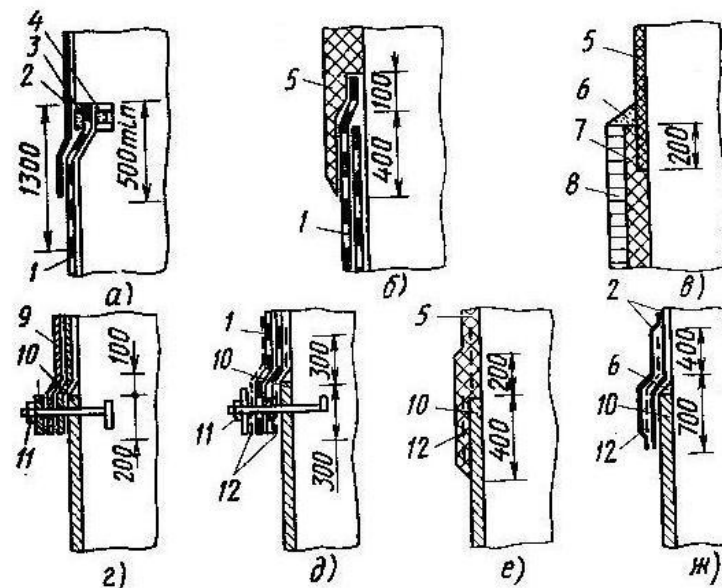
Сопряжения гидроизоляции на вертикальных поверхностях (а—ж):
